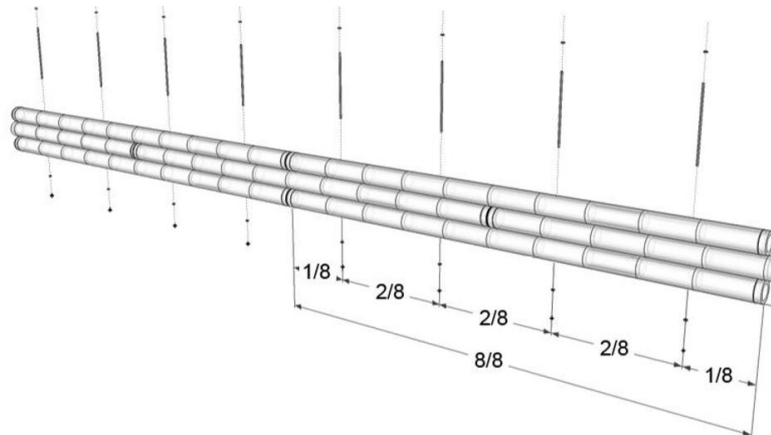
Vigas y Entrepisos. Viga Compuesta Tipo A
